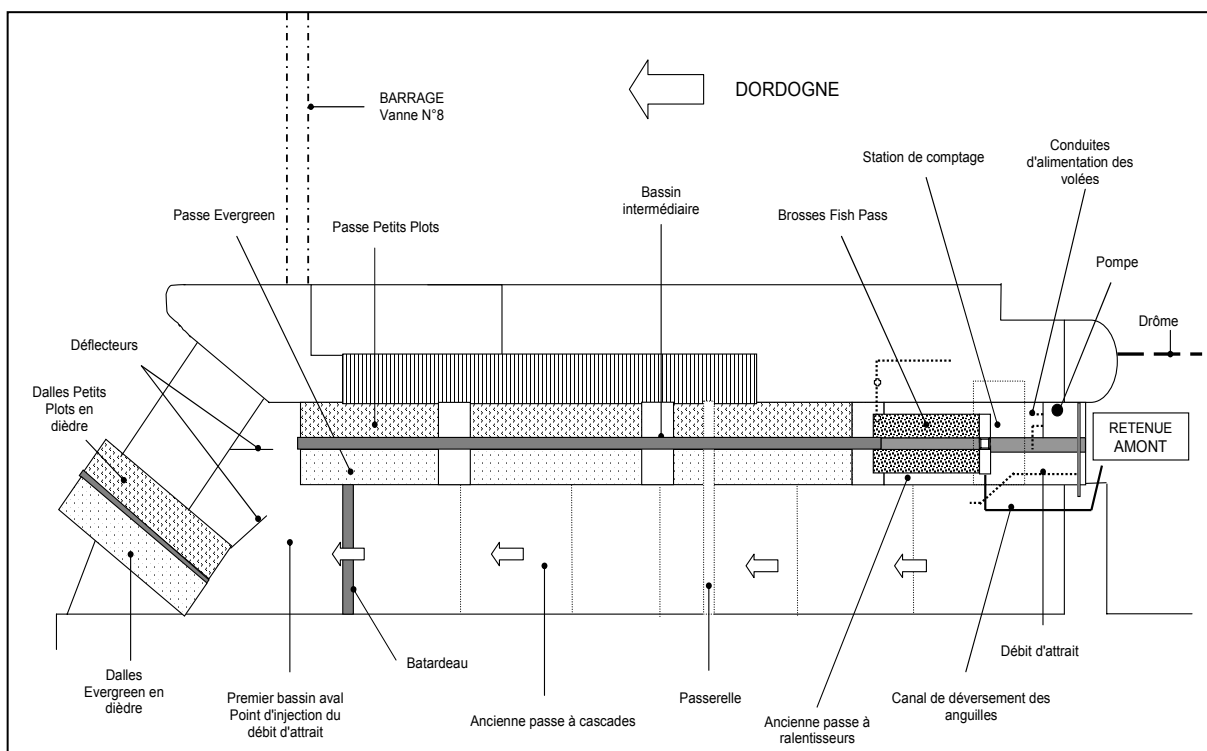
Schéma du dispositif de franchissement spécifique anguilles de Tuilières
